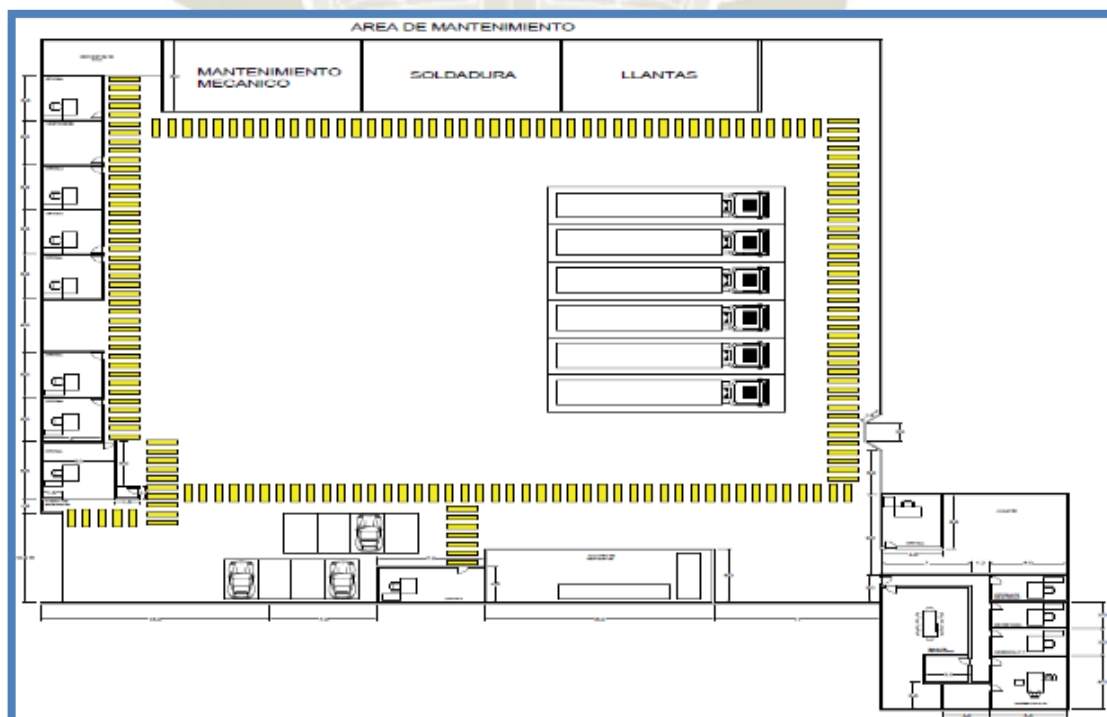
Distribución de la Planta de la Empresa Peru Transport S.R.L
